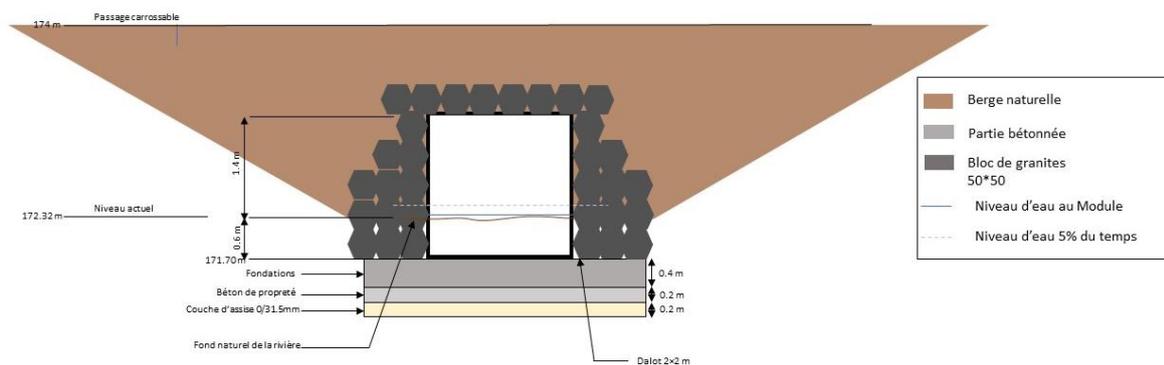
Plan de section amont de la mise en place du franchissement par un dalot de 2/2 m
